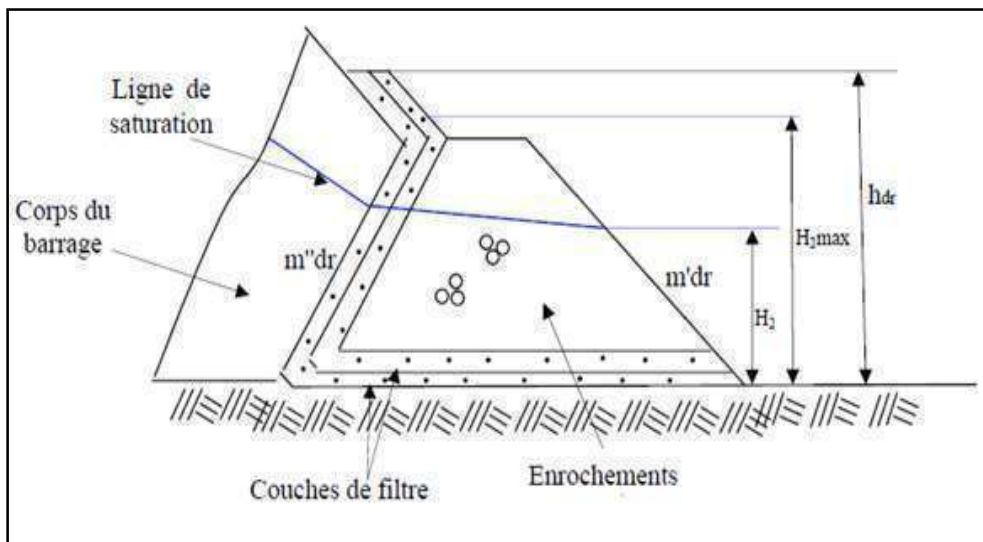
Prisme de drainage avec drainage de surface [3].
